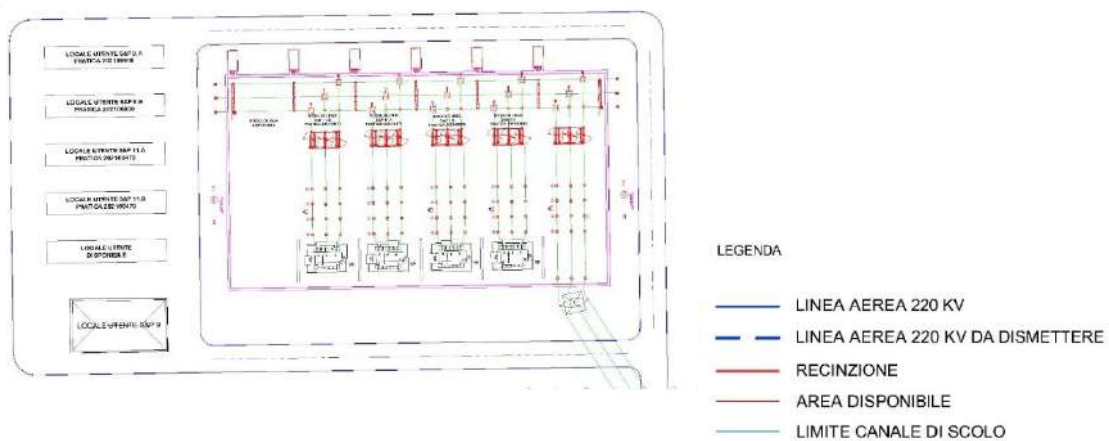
Pianta elettromeccanica generale – Stazione utente
